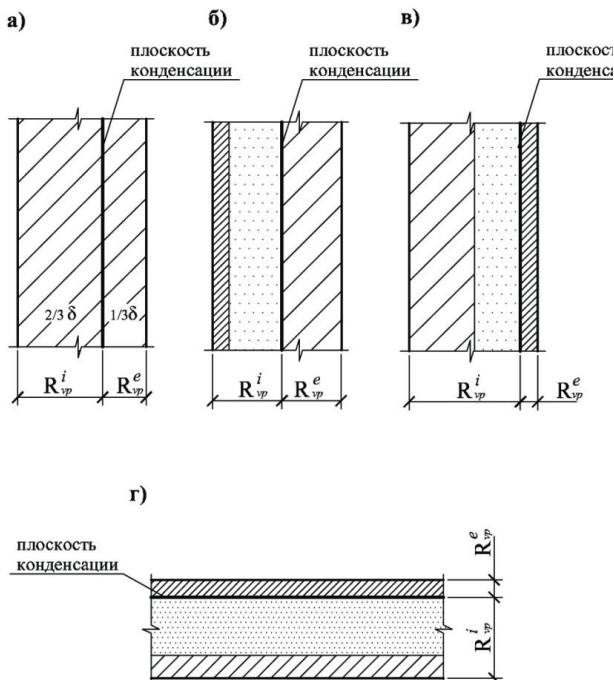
Схемы расположения плоскости вероятной конденсации в наружных ограждающих конструкциях: а – однородная стена; б – стена, утепленная с внутренней стороны; в – то же с наружной стороны; г – покрытие.
